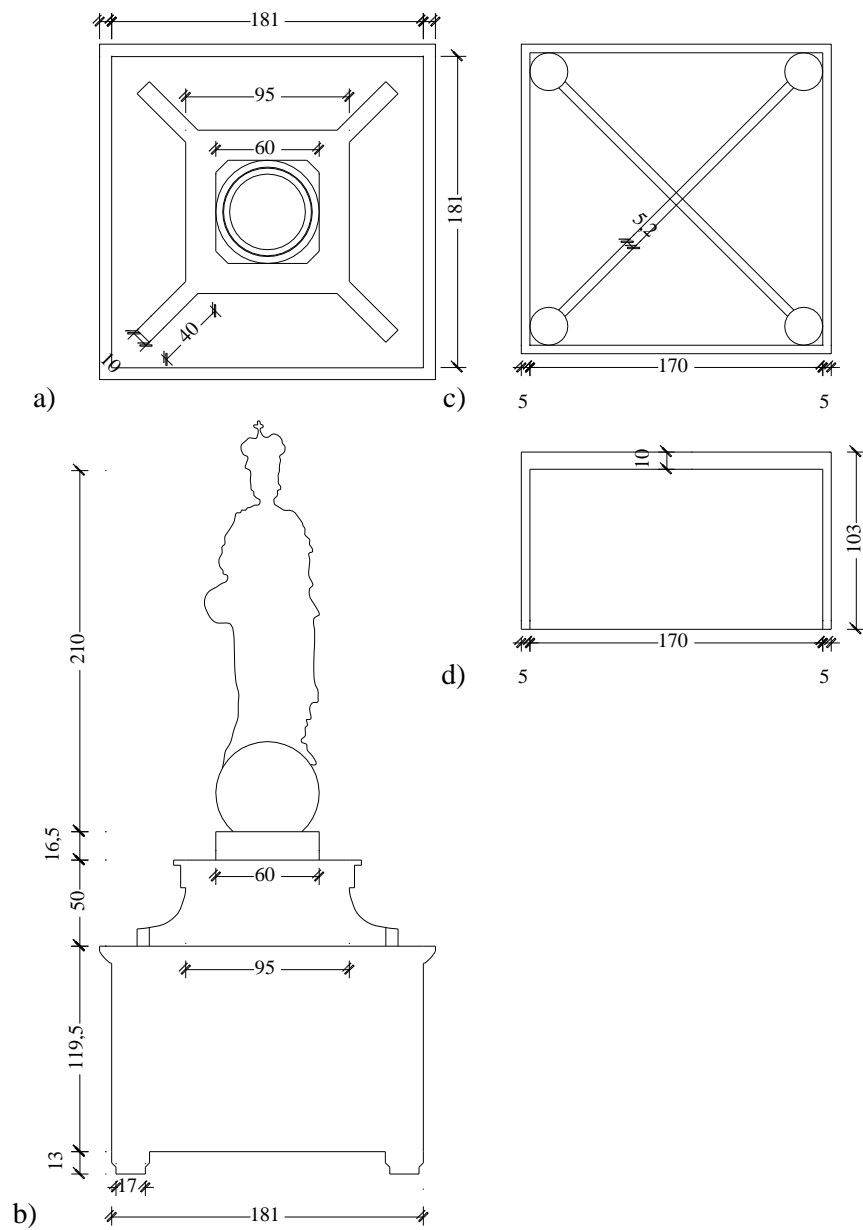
a) Pianta; b) profilo; c) sezione longitudinale fercolo; d) sezione trasversale fercolo.
